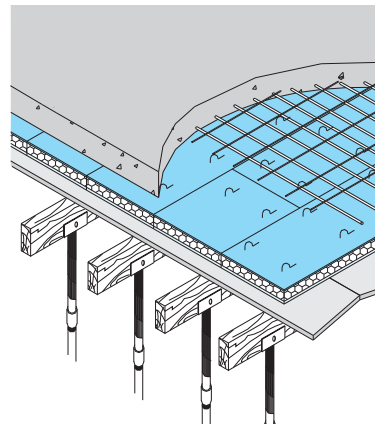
Support continu : ferrailage et coulée du béton sur panneaux agrafés
